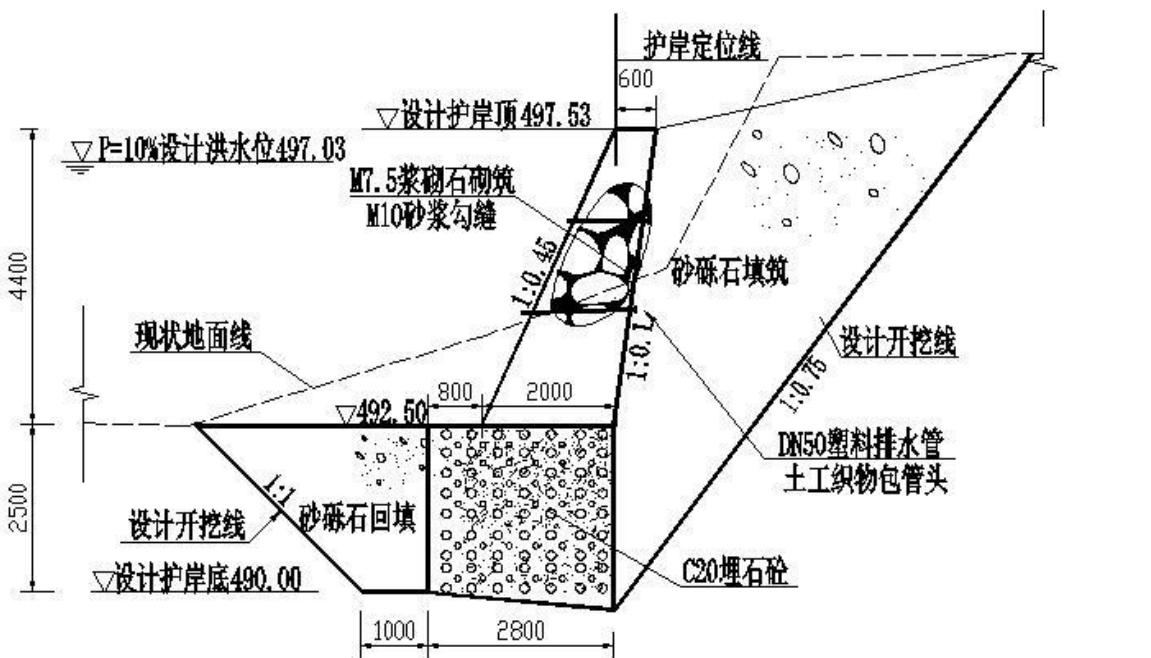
仰斜式浆砌石挡墙（埋石混凝土+浆砌石挡墙）横断面图
